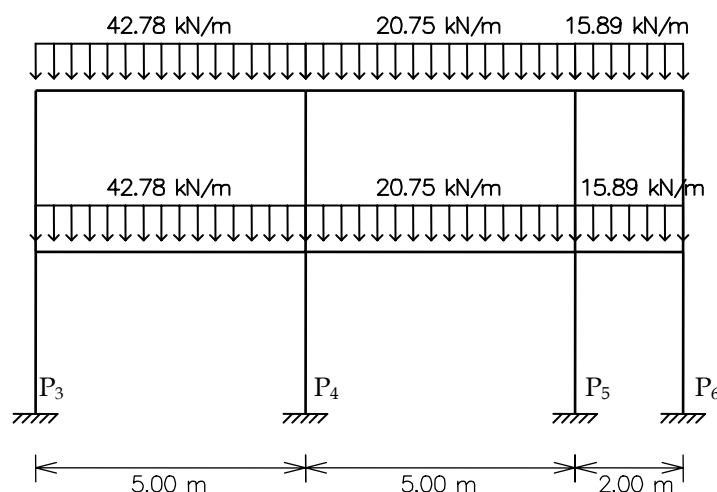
Esquema estrutural do pórtico da viga V_3 do Exemplo 4.
